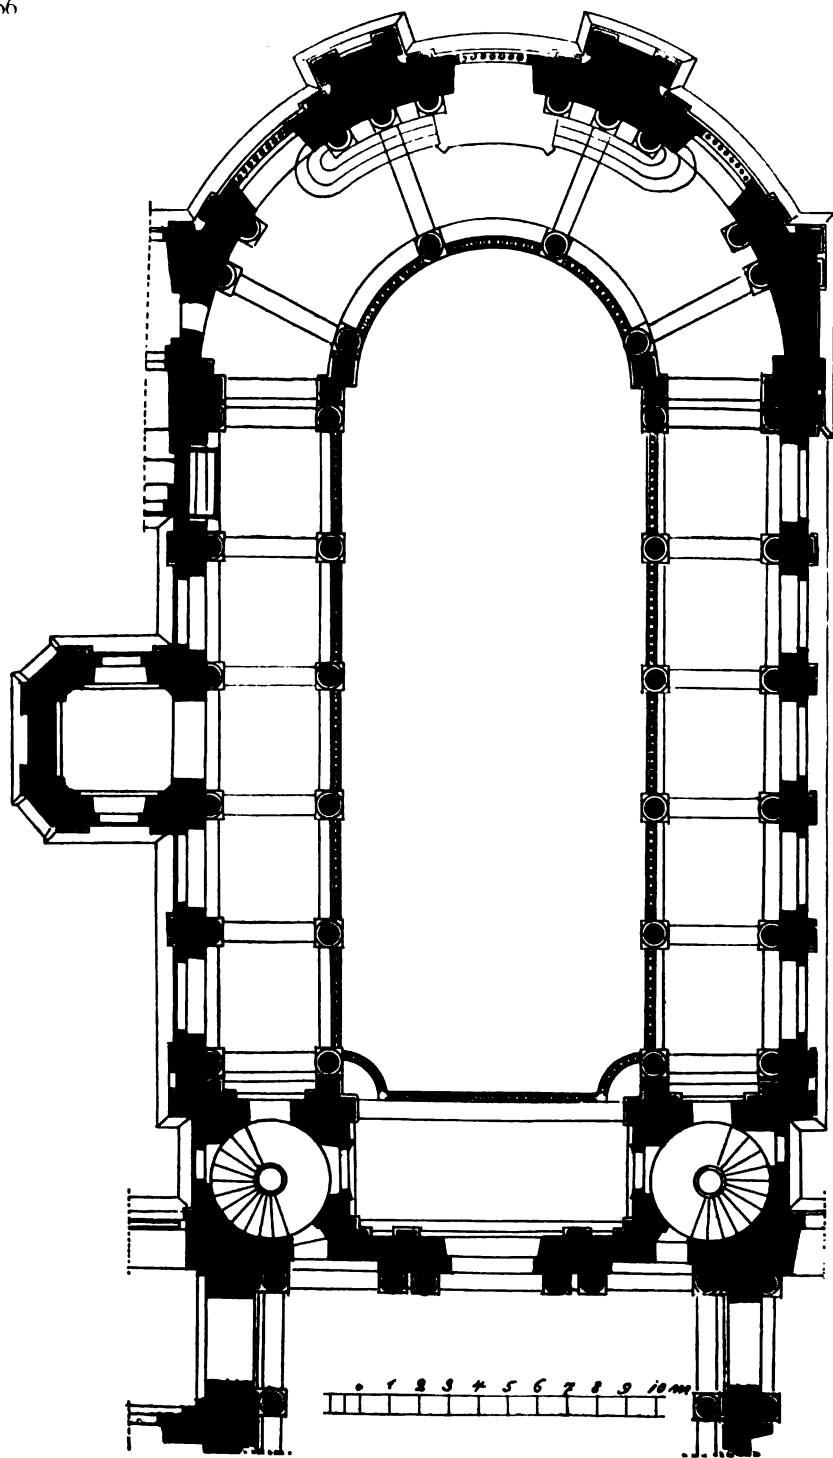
Kapelle von Versailles. Grundriss.
